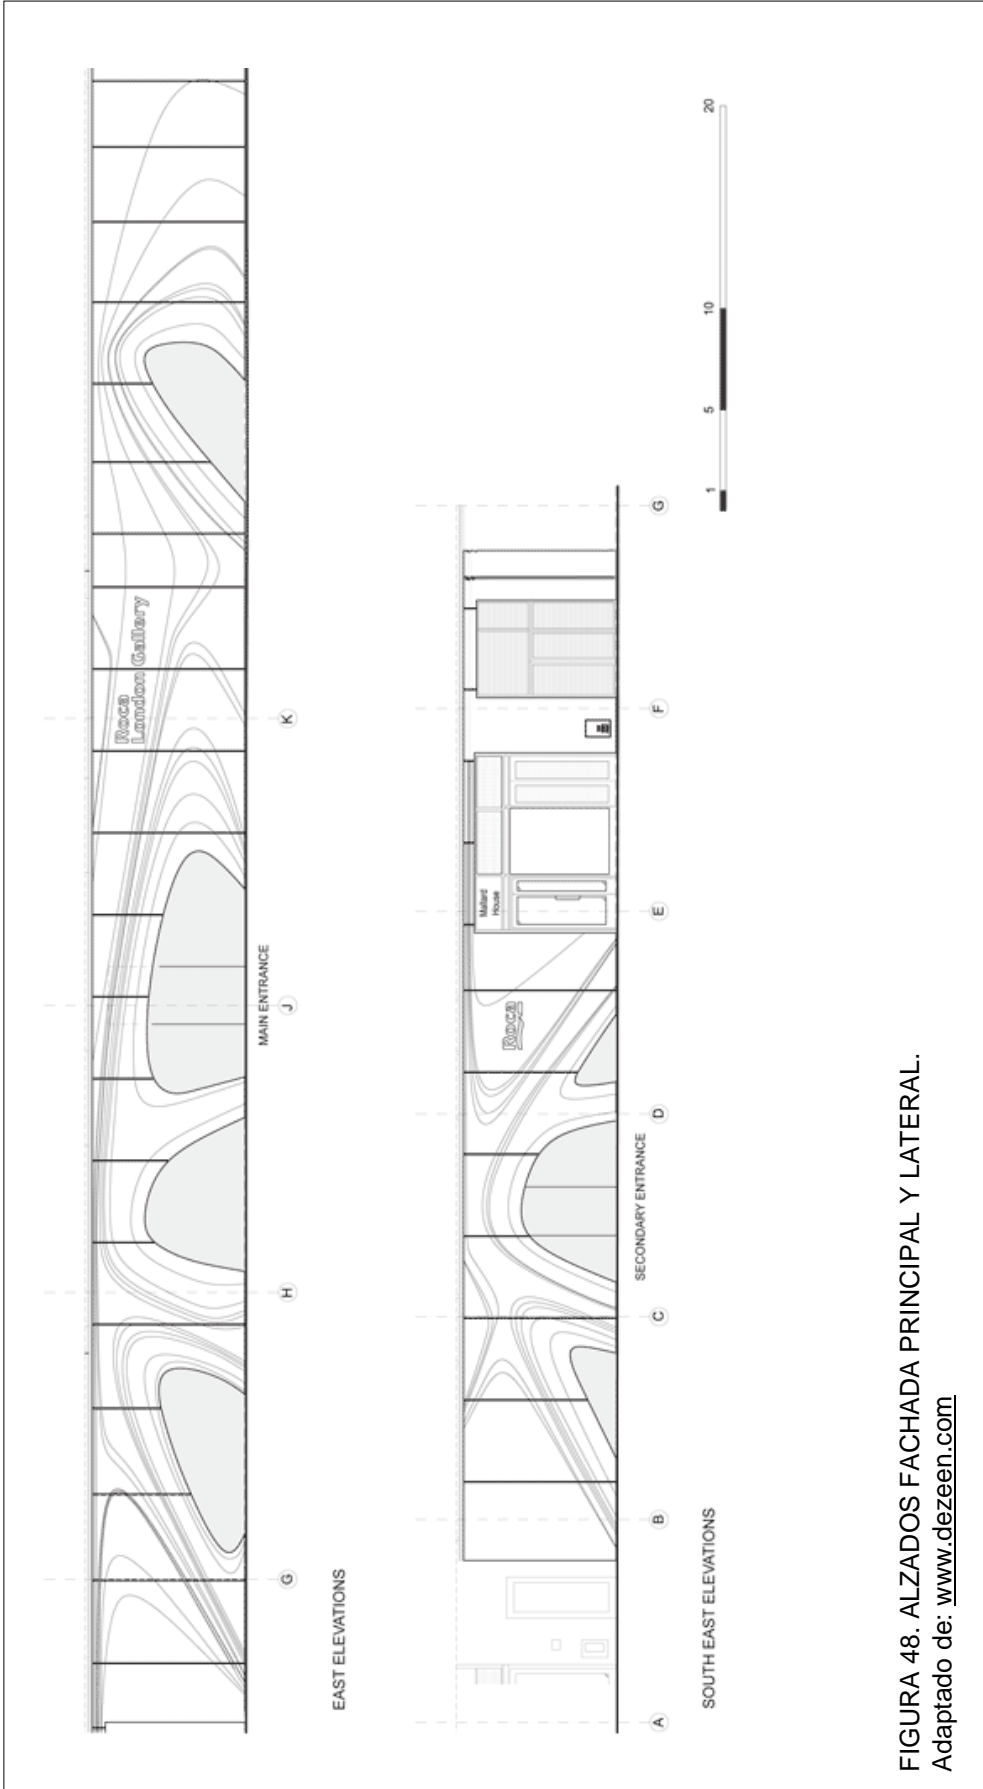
ALZADOS FACHADA PRINCIPAL Y LATERAL.
